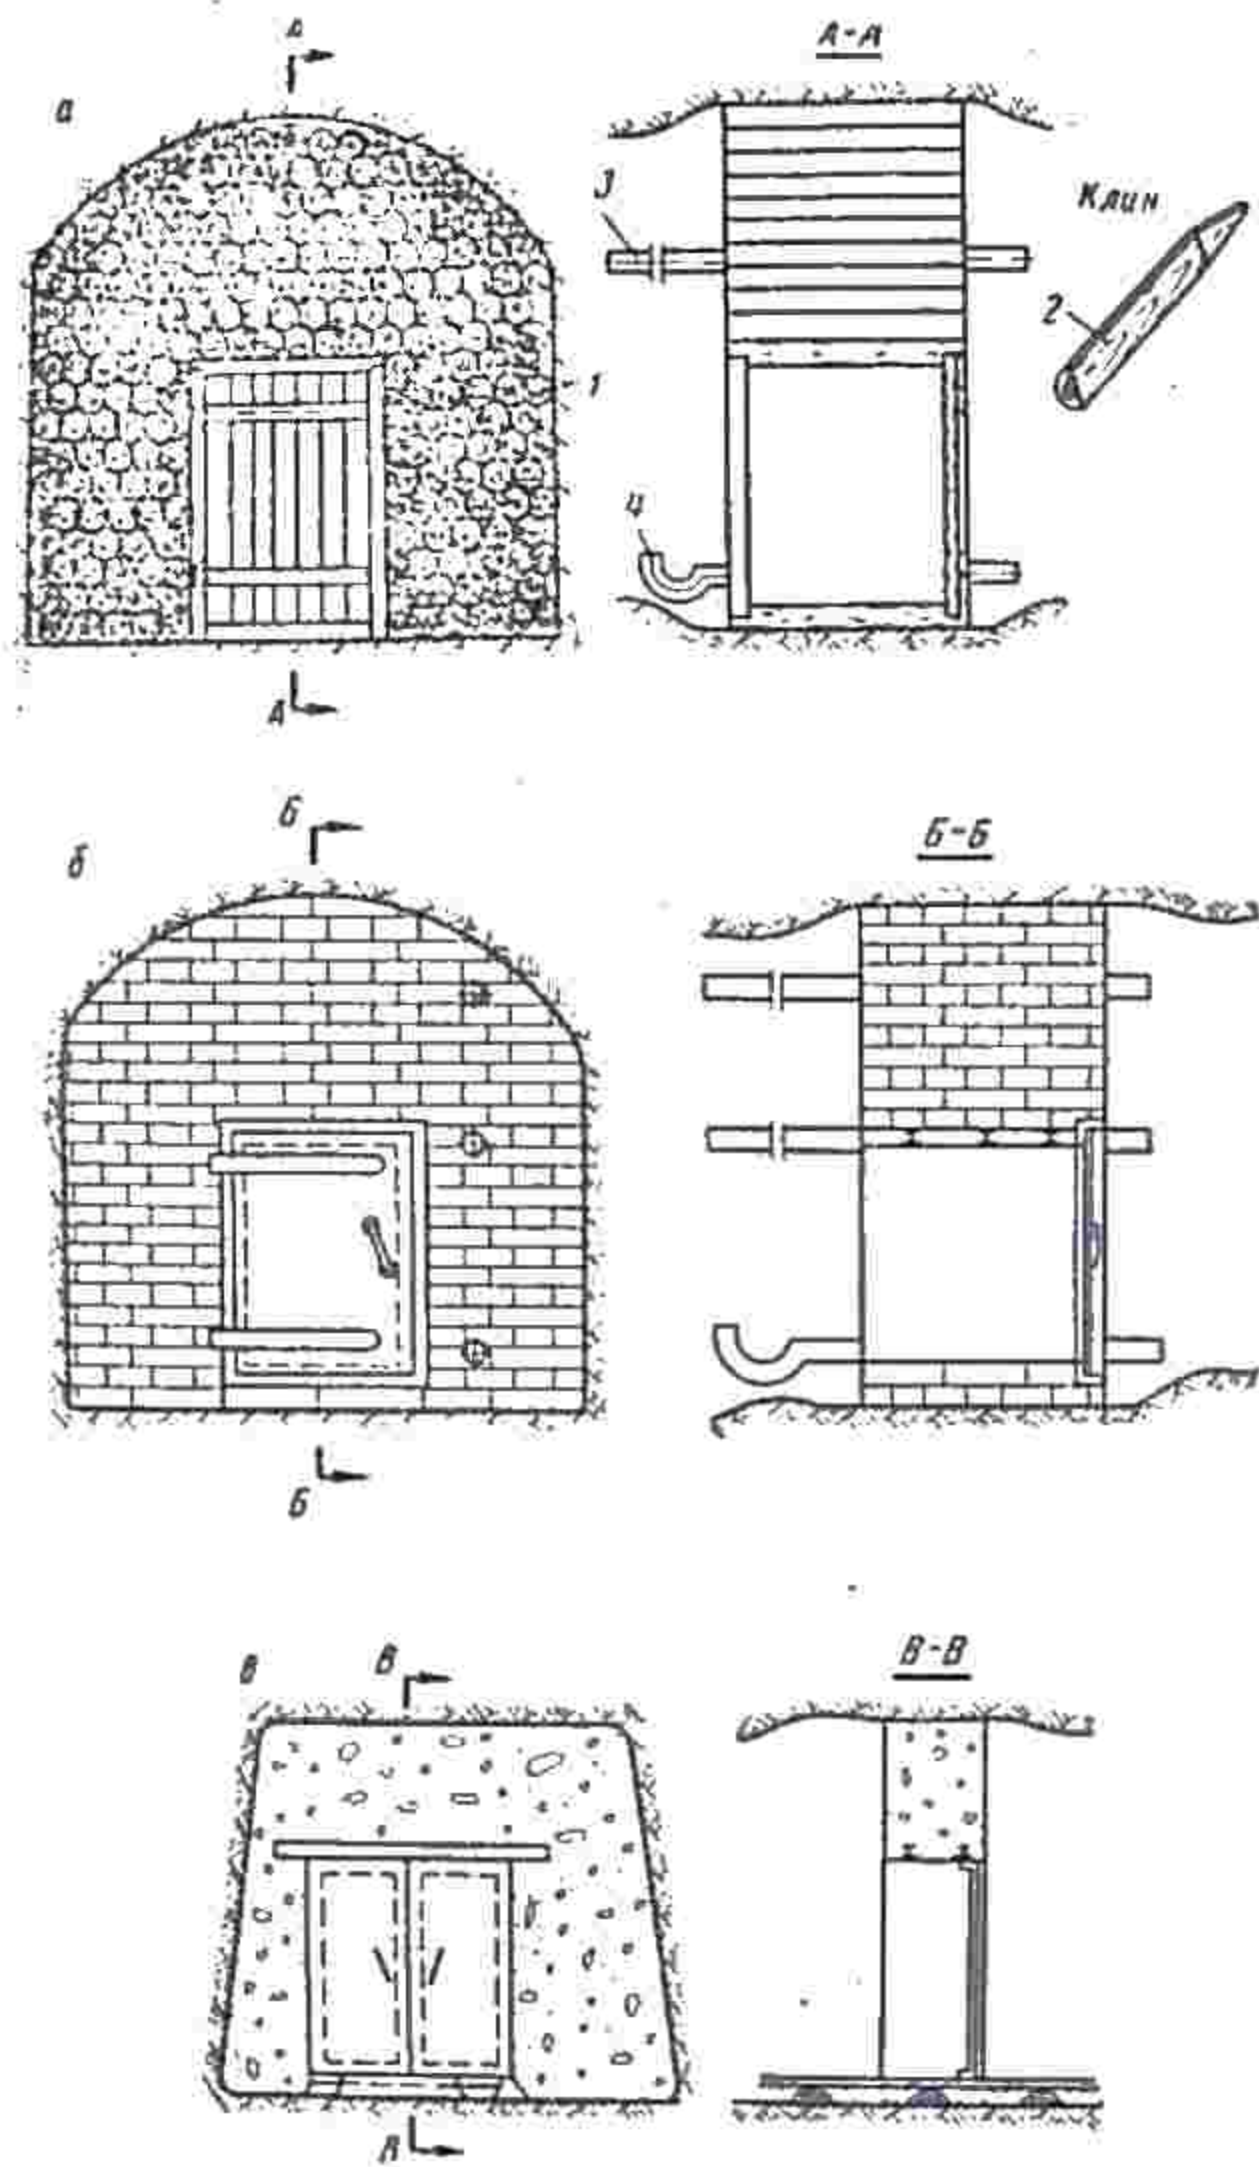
Чураковые, кирпичные и бетонные перемычки
